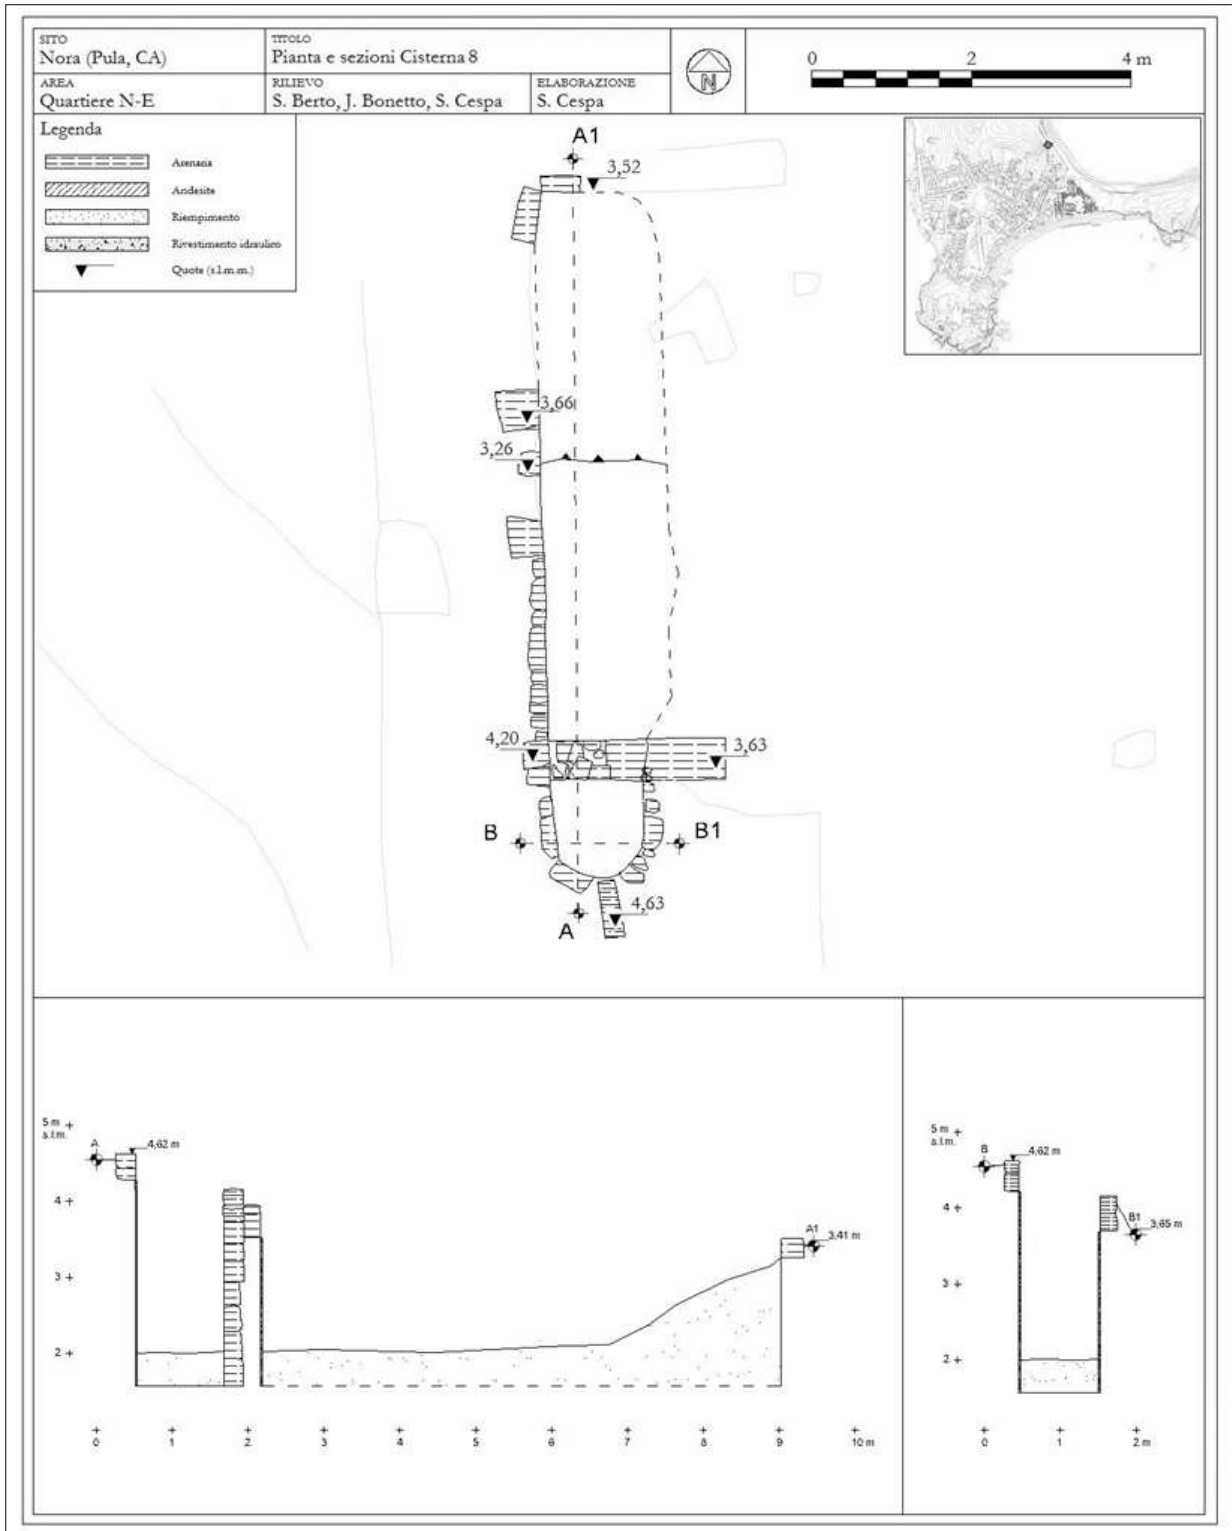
Pianta e sezioni della cisterna 8 (elaborazione dell'autore).
